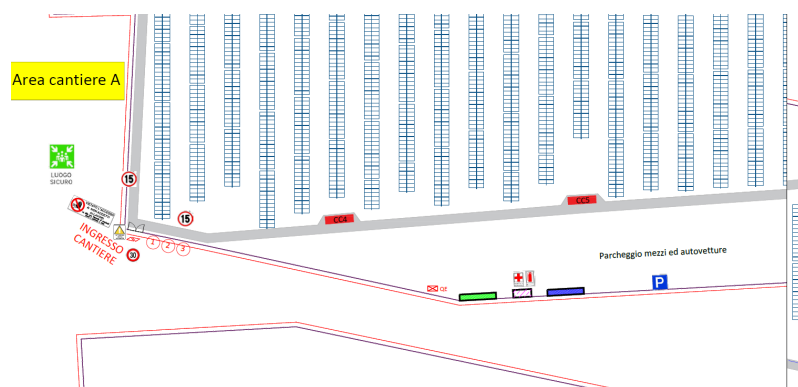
Stralcio planimetria di cantiere_TEC-4
